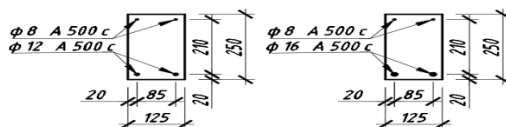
Схемы армирования железобетонных балок с различной формой достижения предельного состояния
